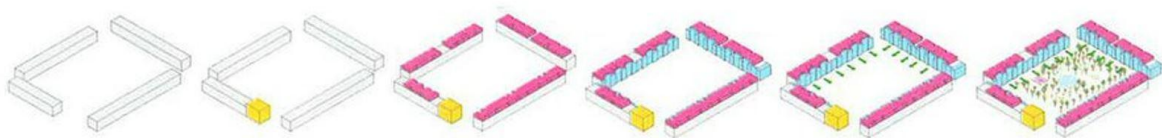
Схематичне зображення прибудов та надбудов (схематичні зображення: Adam Khan Architects, <https://adamkhan.co.uk/projects/ellebo-garden-room/>)
